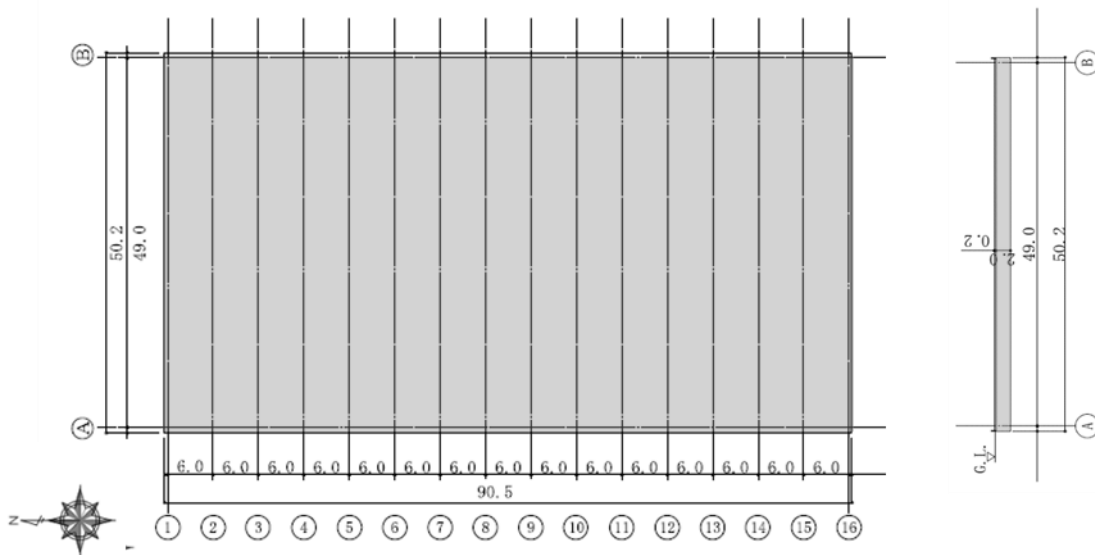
基礎スラブ平面図，断面図（例 10-A, B 貯蔵庫）
